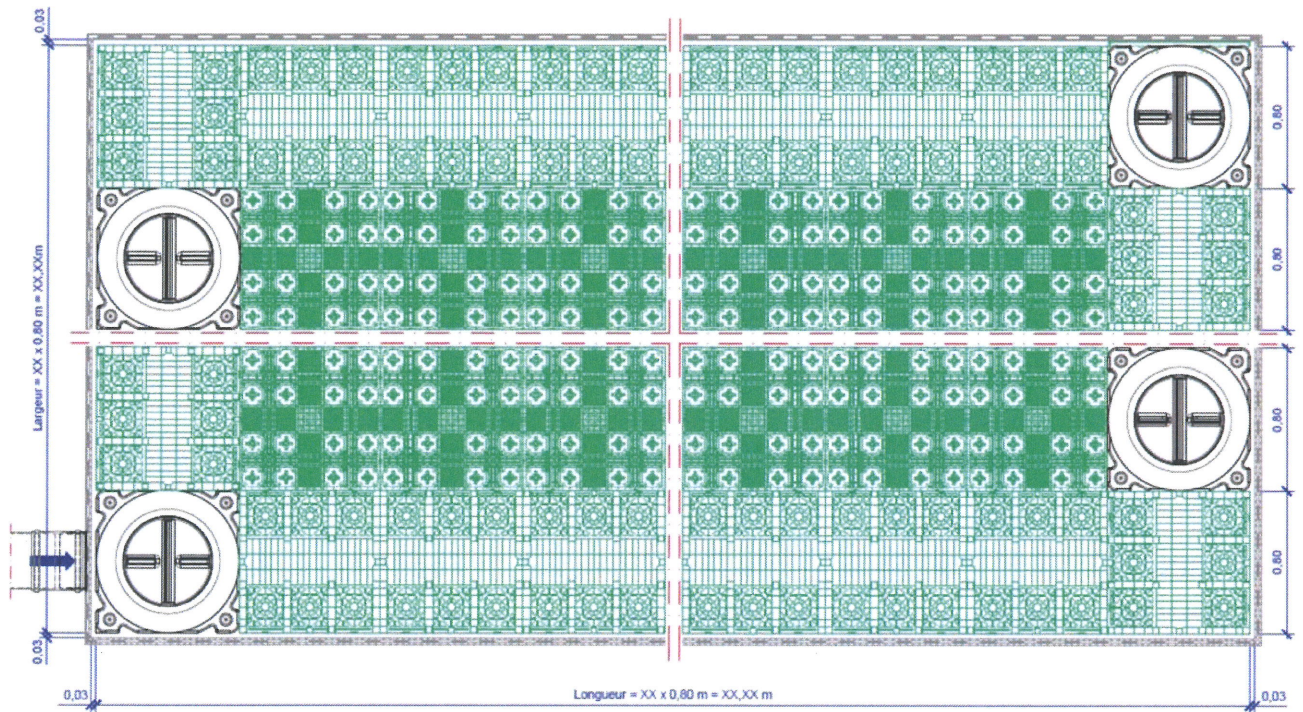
Vue de dessus d'un bassin réalisé en mix Rigofill inspect et ST avec boîte d'inspection intégrée
